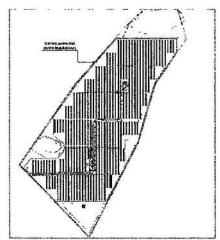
Ubicación en planta de la barrera propuesta para la protección contra inundaciones. Fuente: Enel, 2022
